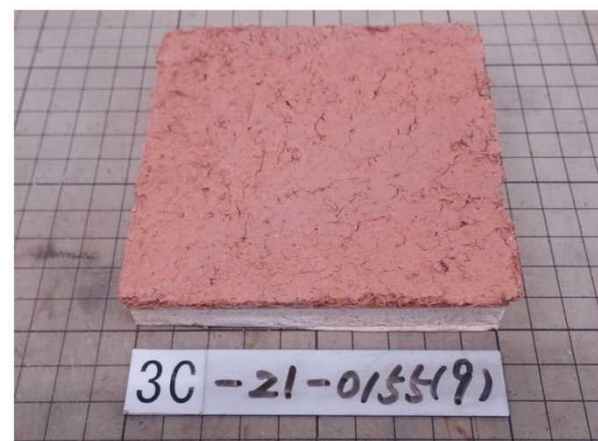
発熱性試験前 (P100-4) : 一般的な仕様
